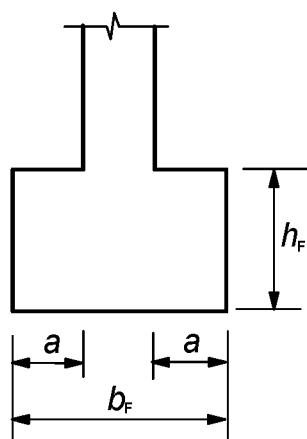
Símbolos para zapatas de hormigón sin armar
